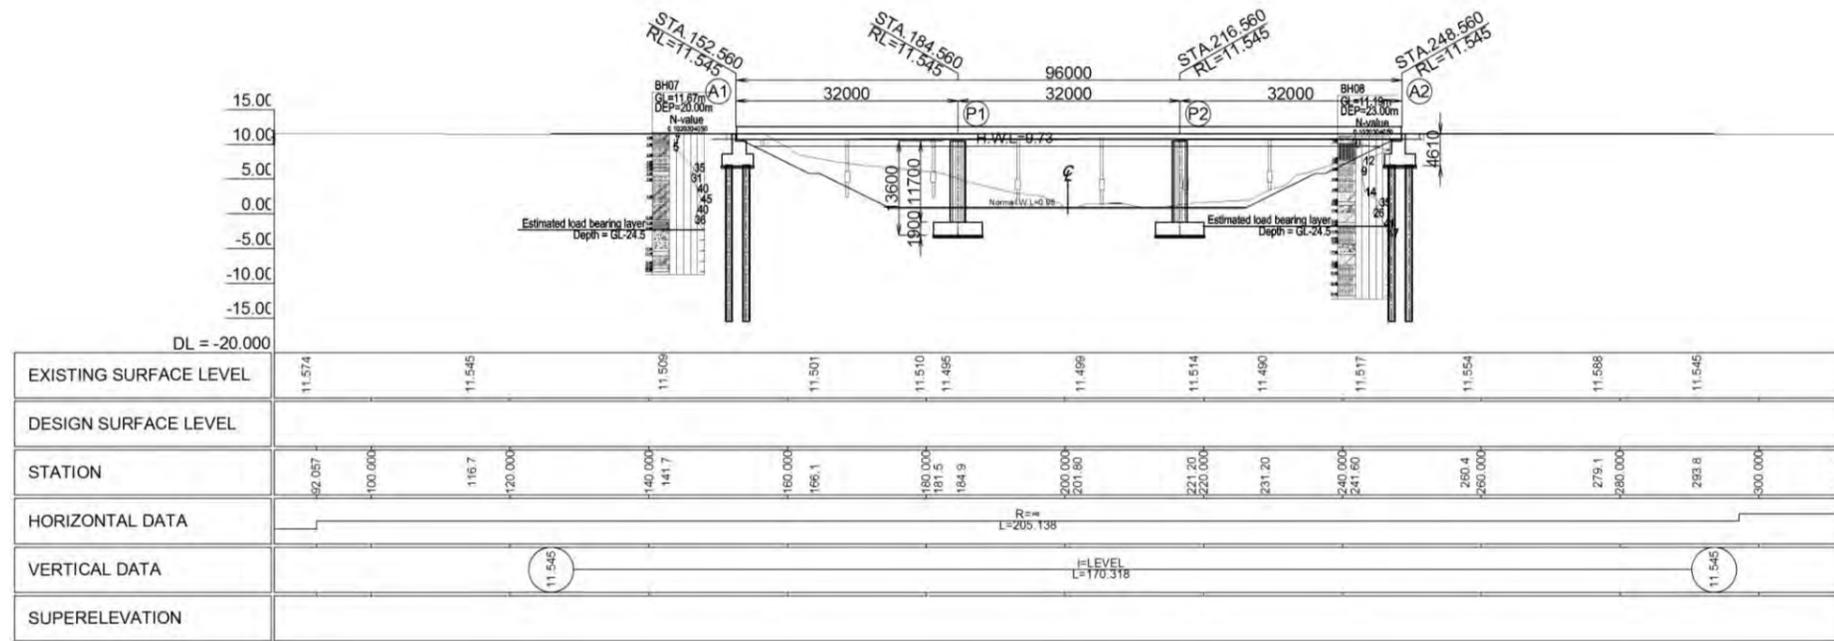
架け替え橋梁一般図(Old Queens Road Bridge – Tramline Bridge -)
